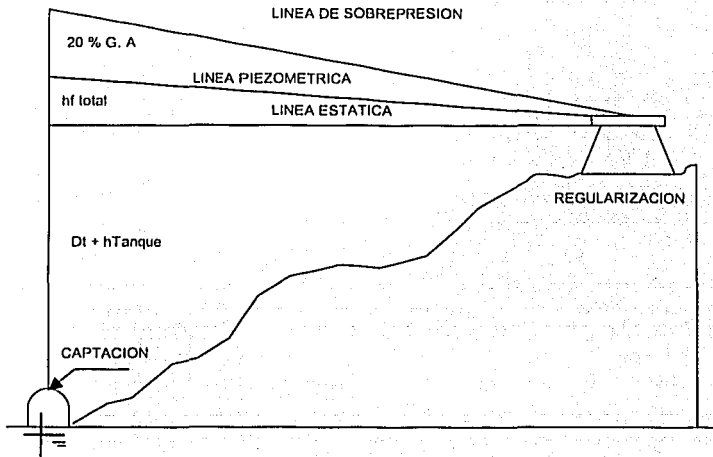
CASO No. 1 TERRENO PLANO Y MEDIO
